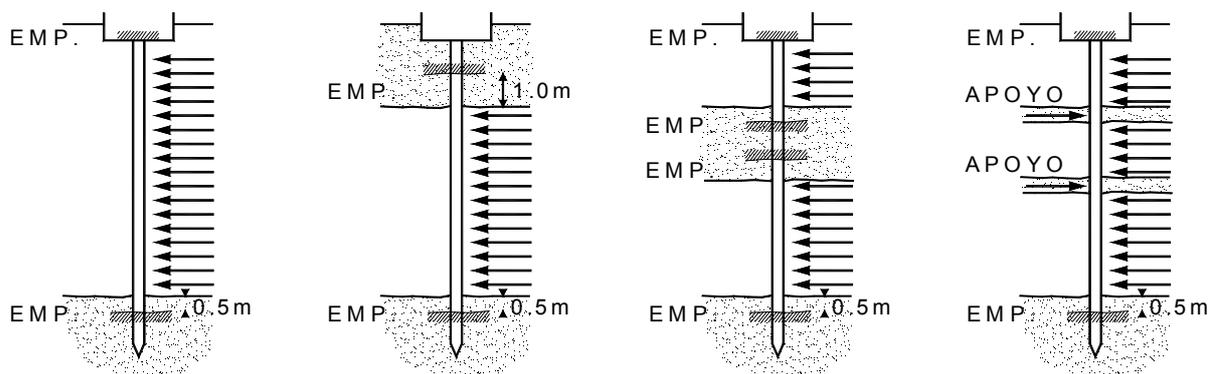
Condiciones de apoyo para el cálculo de esfuerzos en los pilotes
